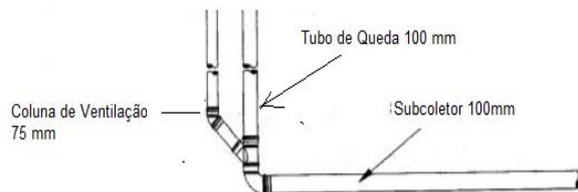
Detalhe da ligação da parte inferior da coluna de ventilação no tubo de queda abaixo do primeiro pavimento.
